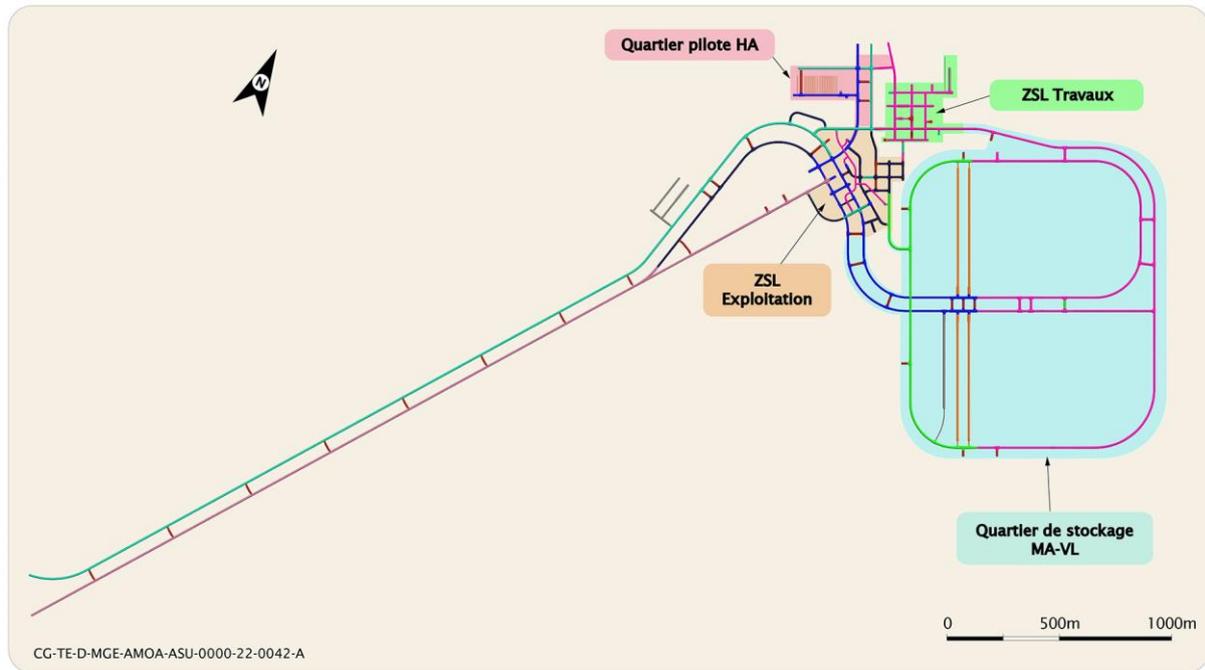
Illustration des ouvrages souterrains construits lors de la phase de construction initiale (en tranche 1)
